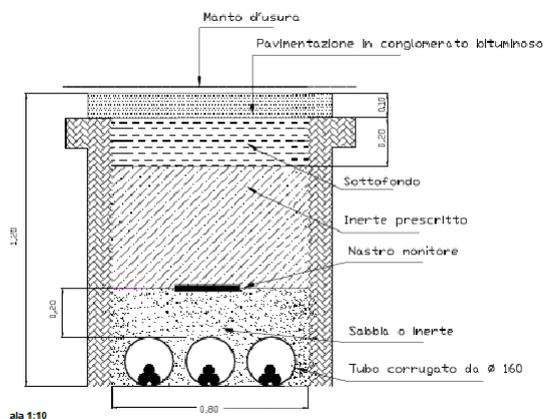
Sezione su strada asfaltata - posa di n°2 cavi AT.
